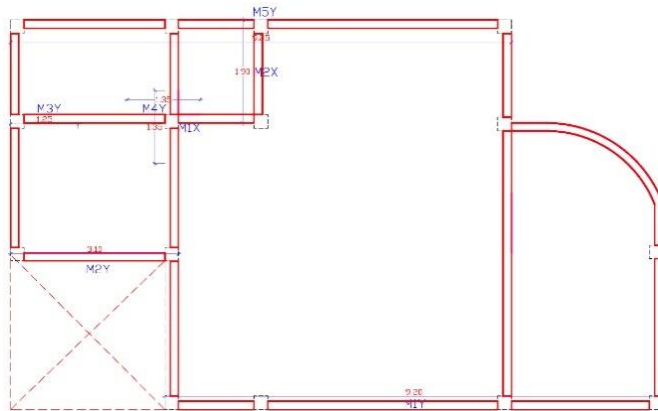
Secciones donde se requiere intervención (Proyección de columnas sobre la losa)
